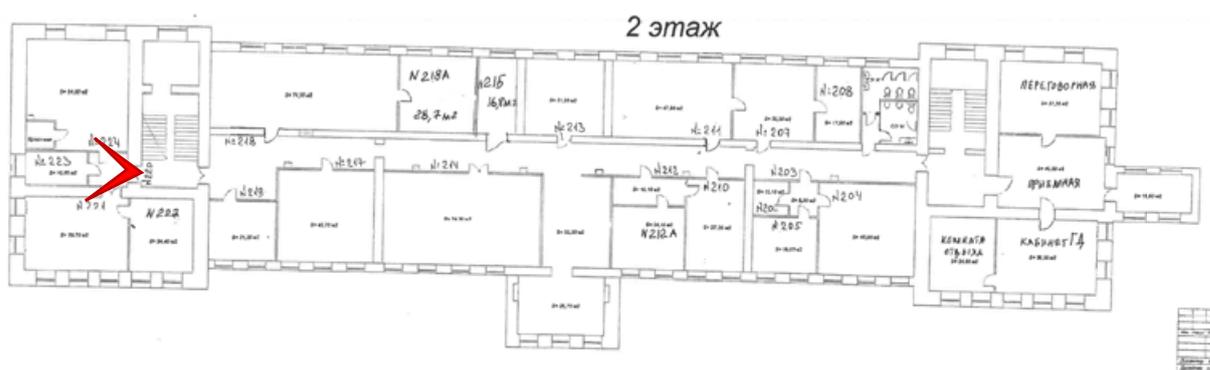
2 этаж. Помещение 4-Н(2,3).
